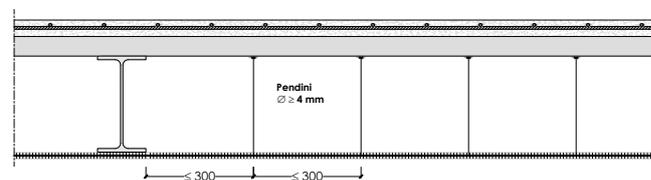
Schema di applicazione orizzontale continua (applicazione a plenum)
